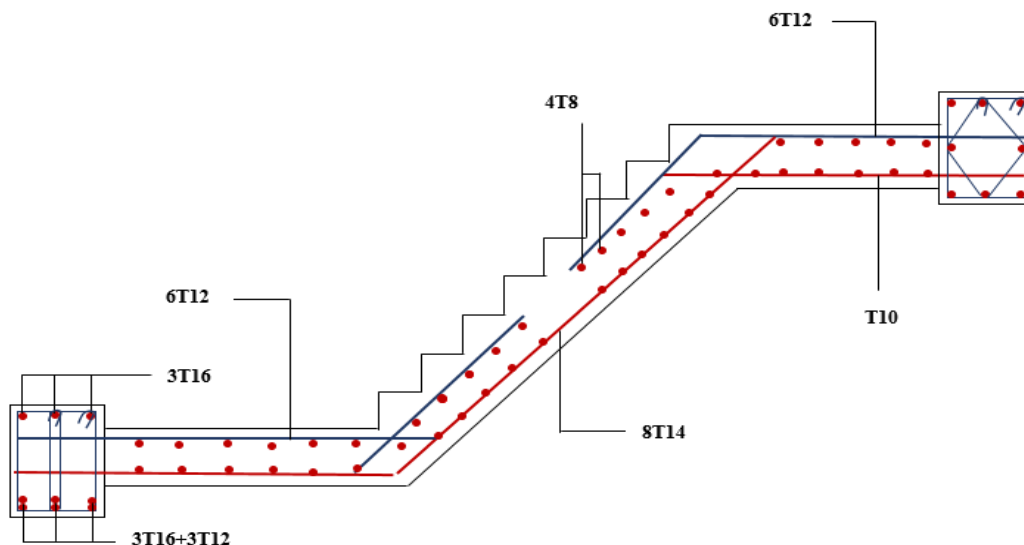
Ferrailage d'escalier (2^{eme} volée).
